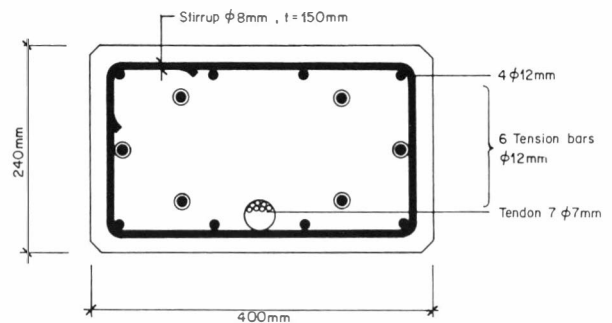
Querschnitt der teilweise vorgespannten Versuchsbalken (Balkenmitte) – Section de la poutre d'essais partiellement précontrainte (milieu de la poutre) – Cross-section of the partially prestressed test beams (mid-beam)
